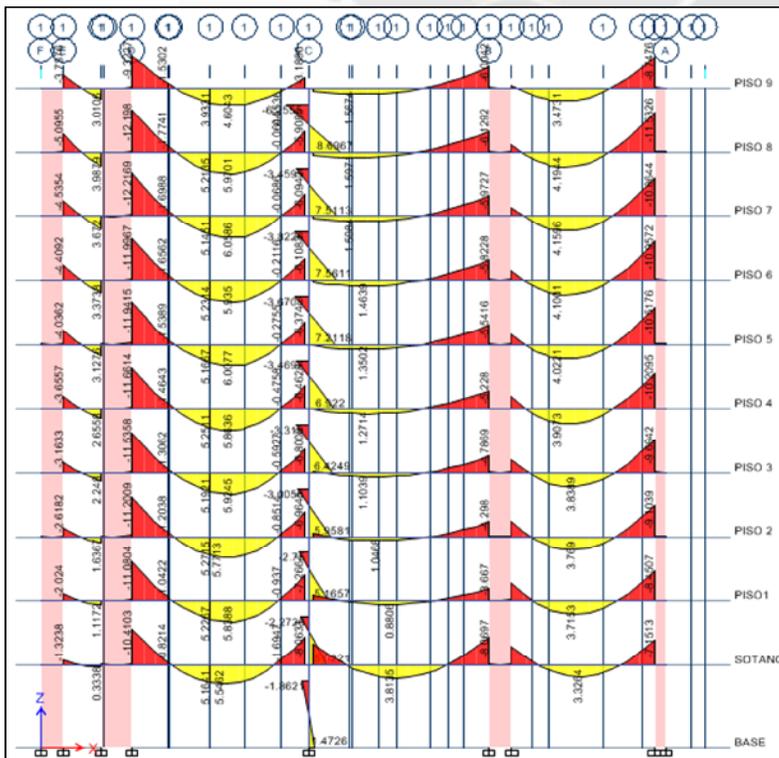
Fuerzas Internas Actuales sobre el Pórtico “1” Debido a las C.M.
